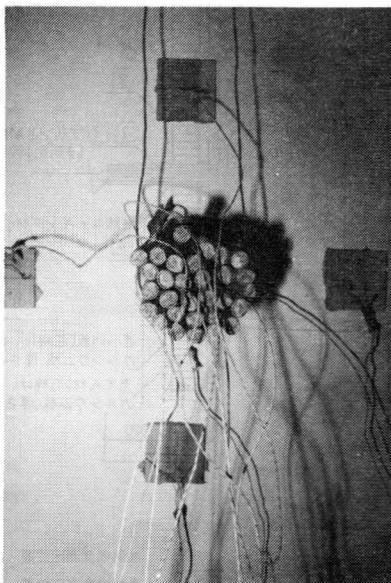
試験体の加熱前のグループケーブルの状態(裏側)
